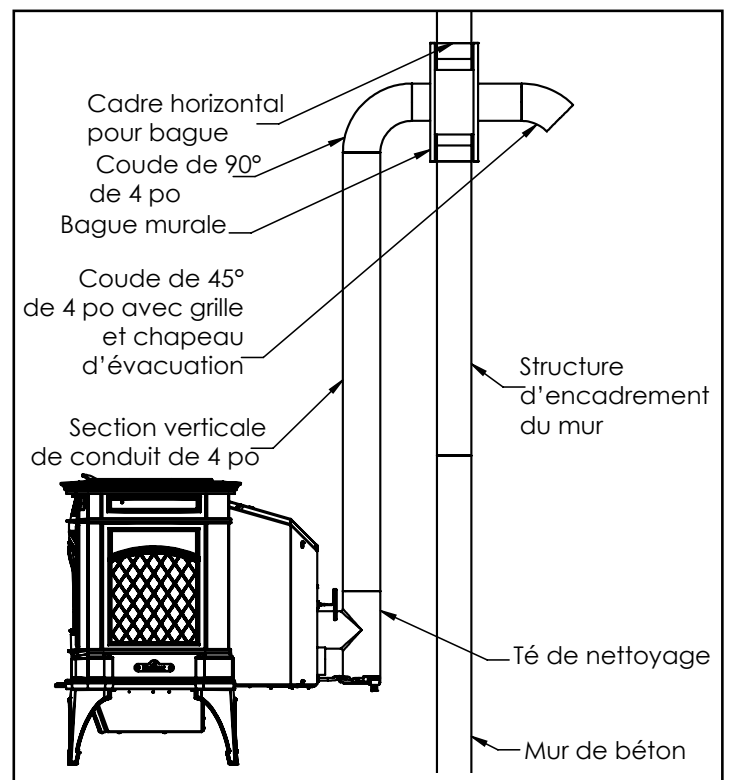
Évacuation avec un mur en béton en arrière de l'unité.
